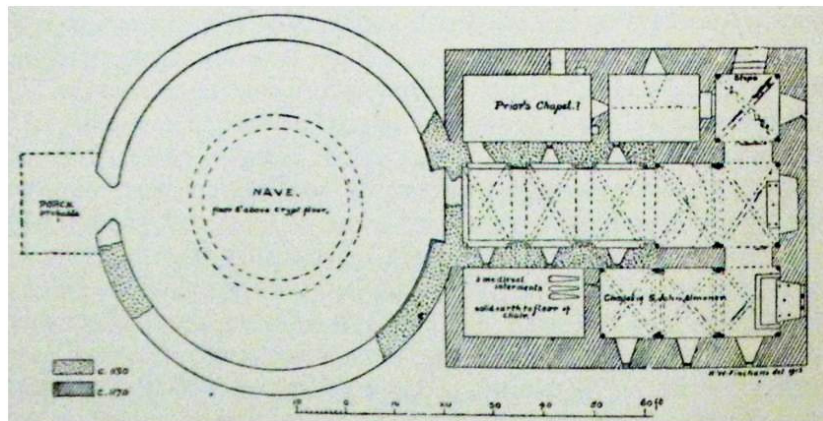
Grundriss, St. John, Clerkenwell, London, 1140-1185.
